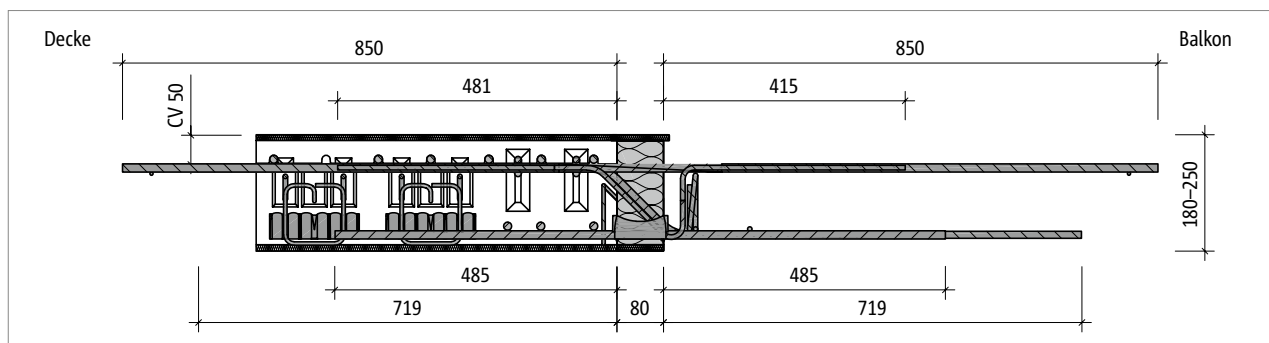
Schöck Isokorb® T Typ C-M3: Produktschnitt
